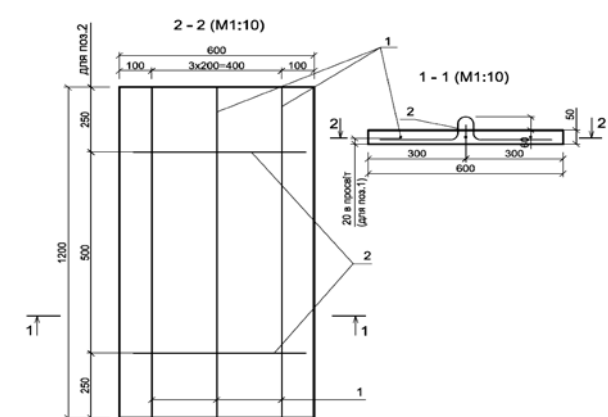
Конструкція плити опалубки ПО–3
